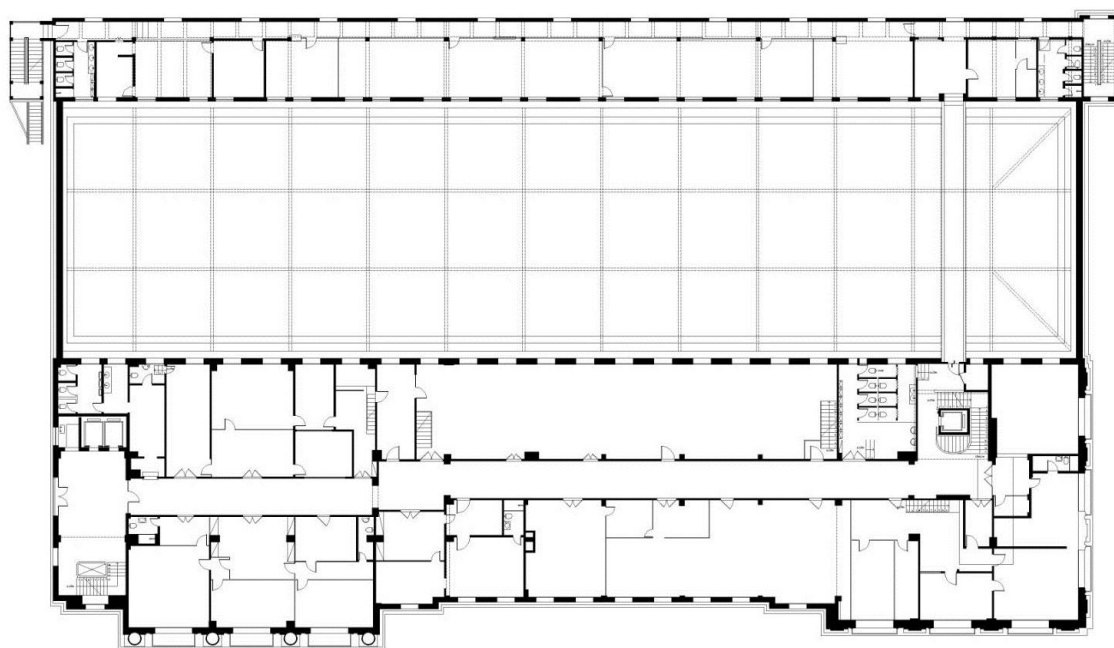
Planta baixa, 2º pavimento – Situação atual
